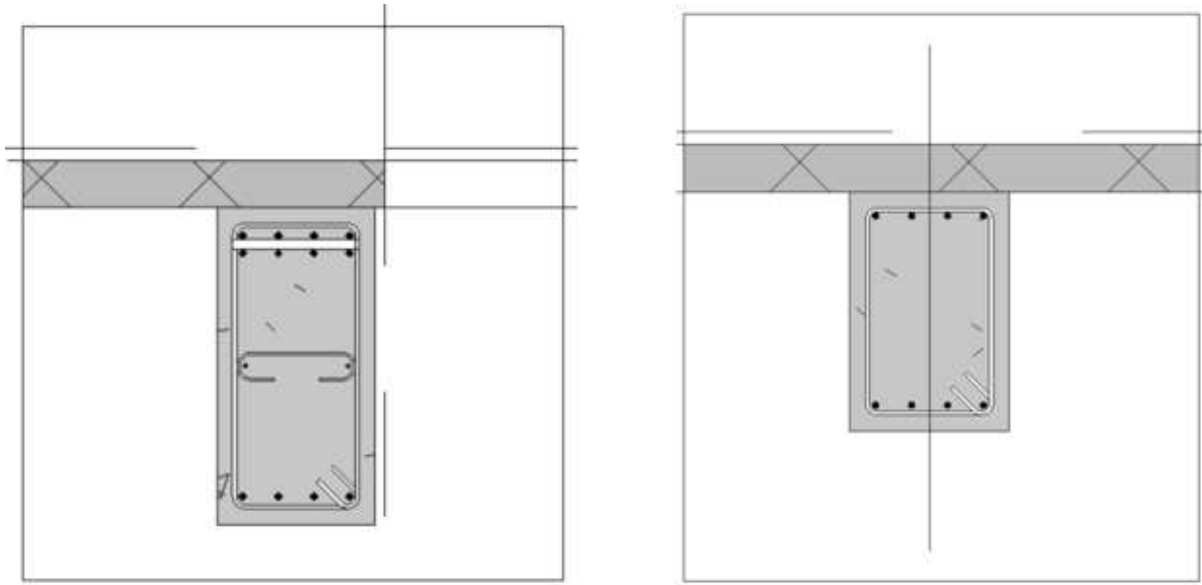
Mô hình kết cấu cốt thép cấu kiện cột, dầm, sàn, cầu thang bộ
